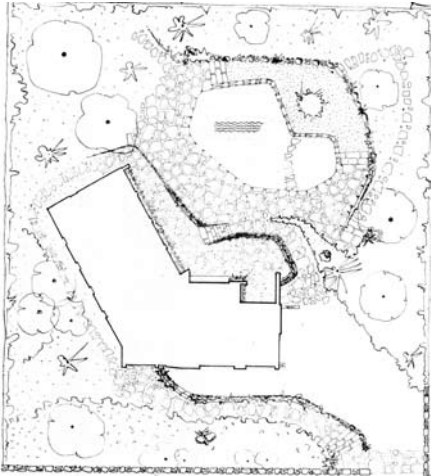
Casa Paulina Giralt Rius, António Baroseiro, 1964. Planta de implantação.
